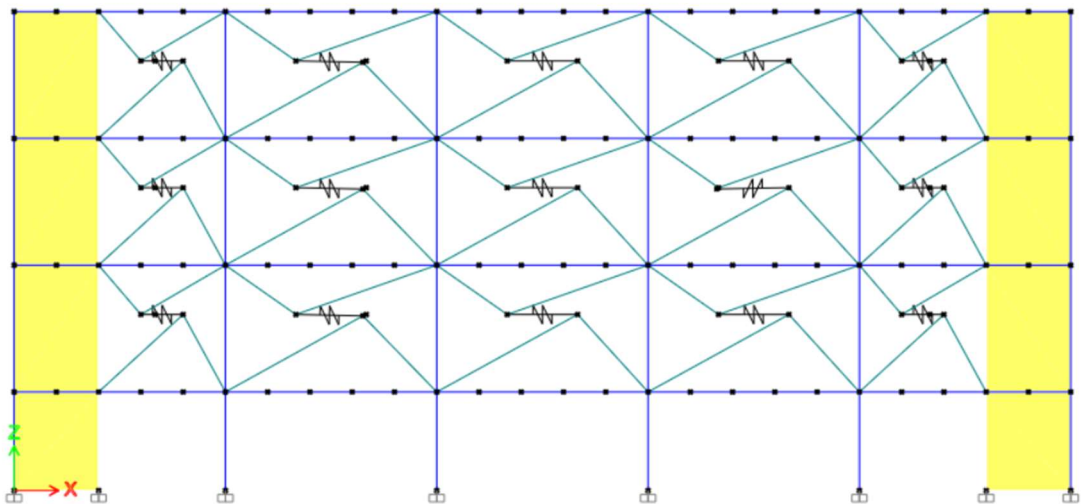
Modelado de la estructura I de la Mampostería a considerar en Eje C
